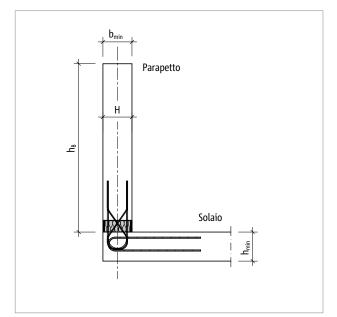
Schöck Isokorb® T tipo AP: sistema statico con altezza del parapetto h_B ; altezza H Isokorb®
